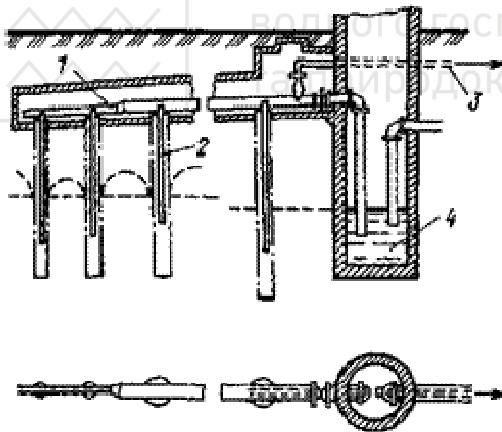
Схема влаштування вертикального дренажу з сифоном:
